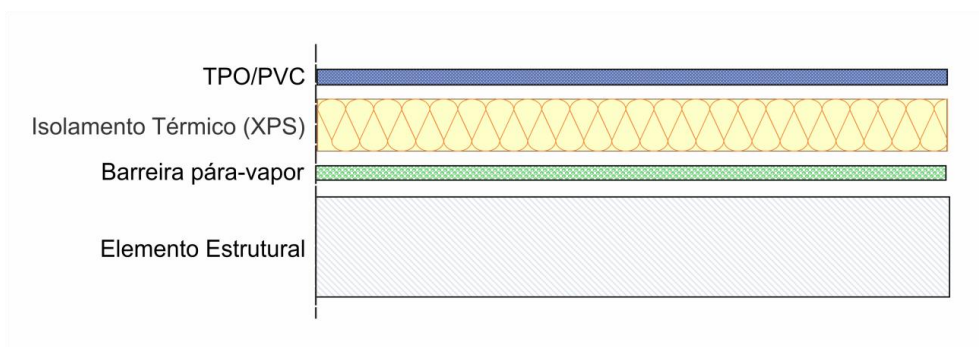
Aplicação de impermeabilização com manta elastomérica com isolamento térmico
